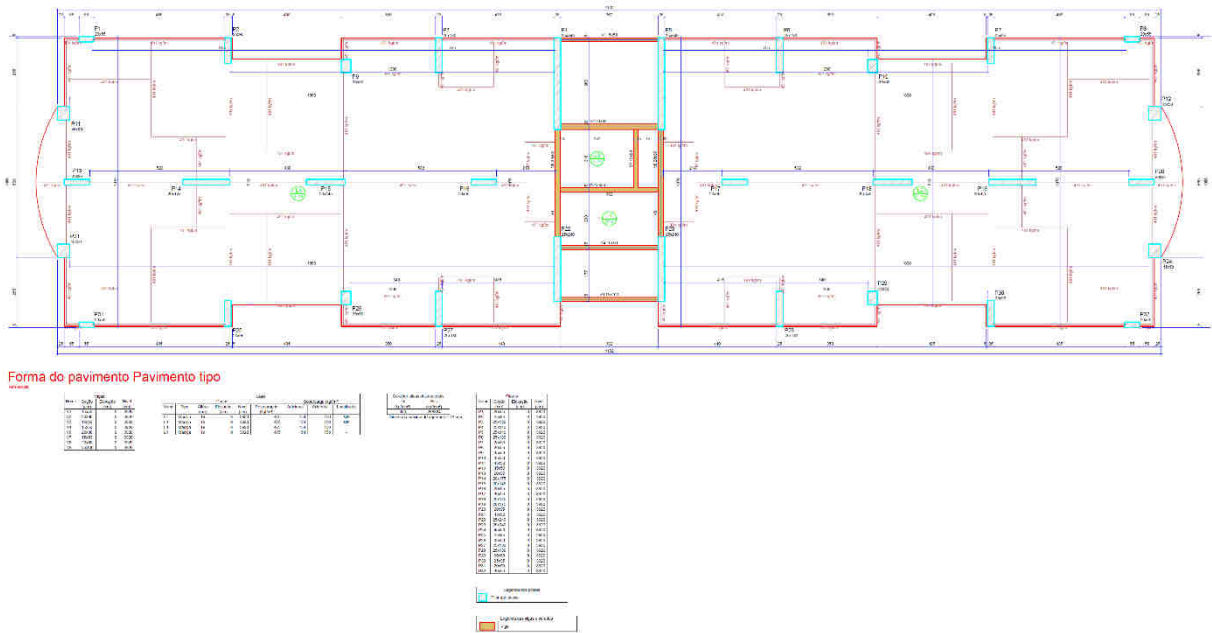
croqui do pavimento tipo gerada pelo programa Eberick – Modelo 3 – Lajes Lisas adaptado – espessura das lajes +5cm
